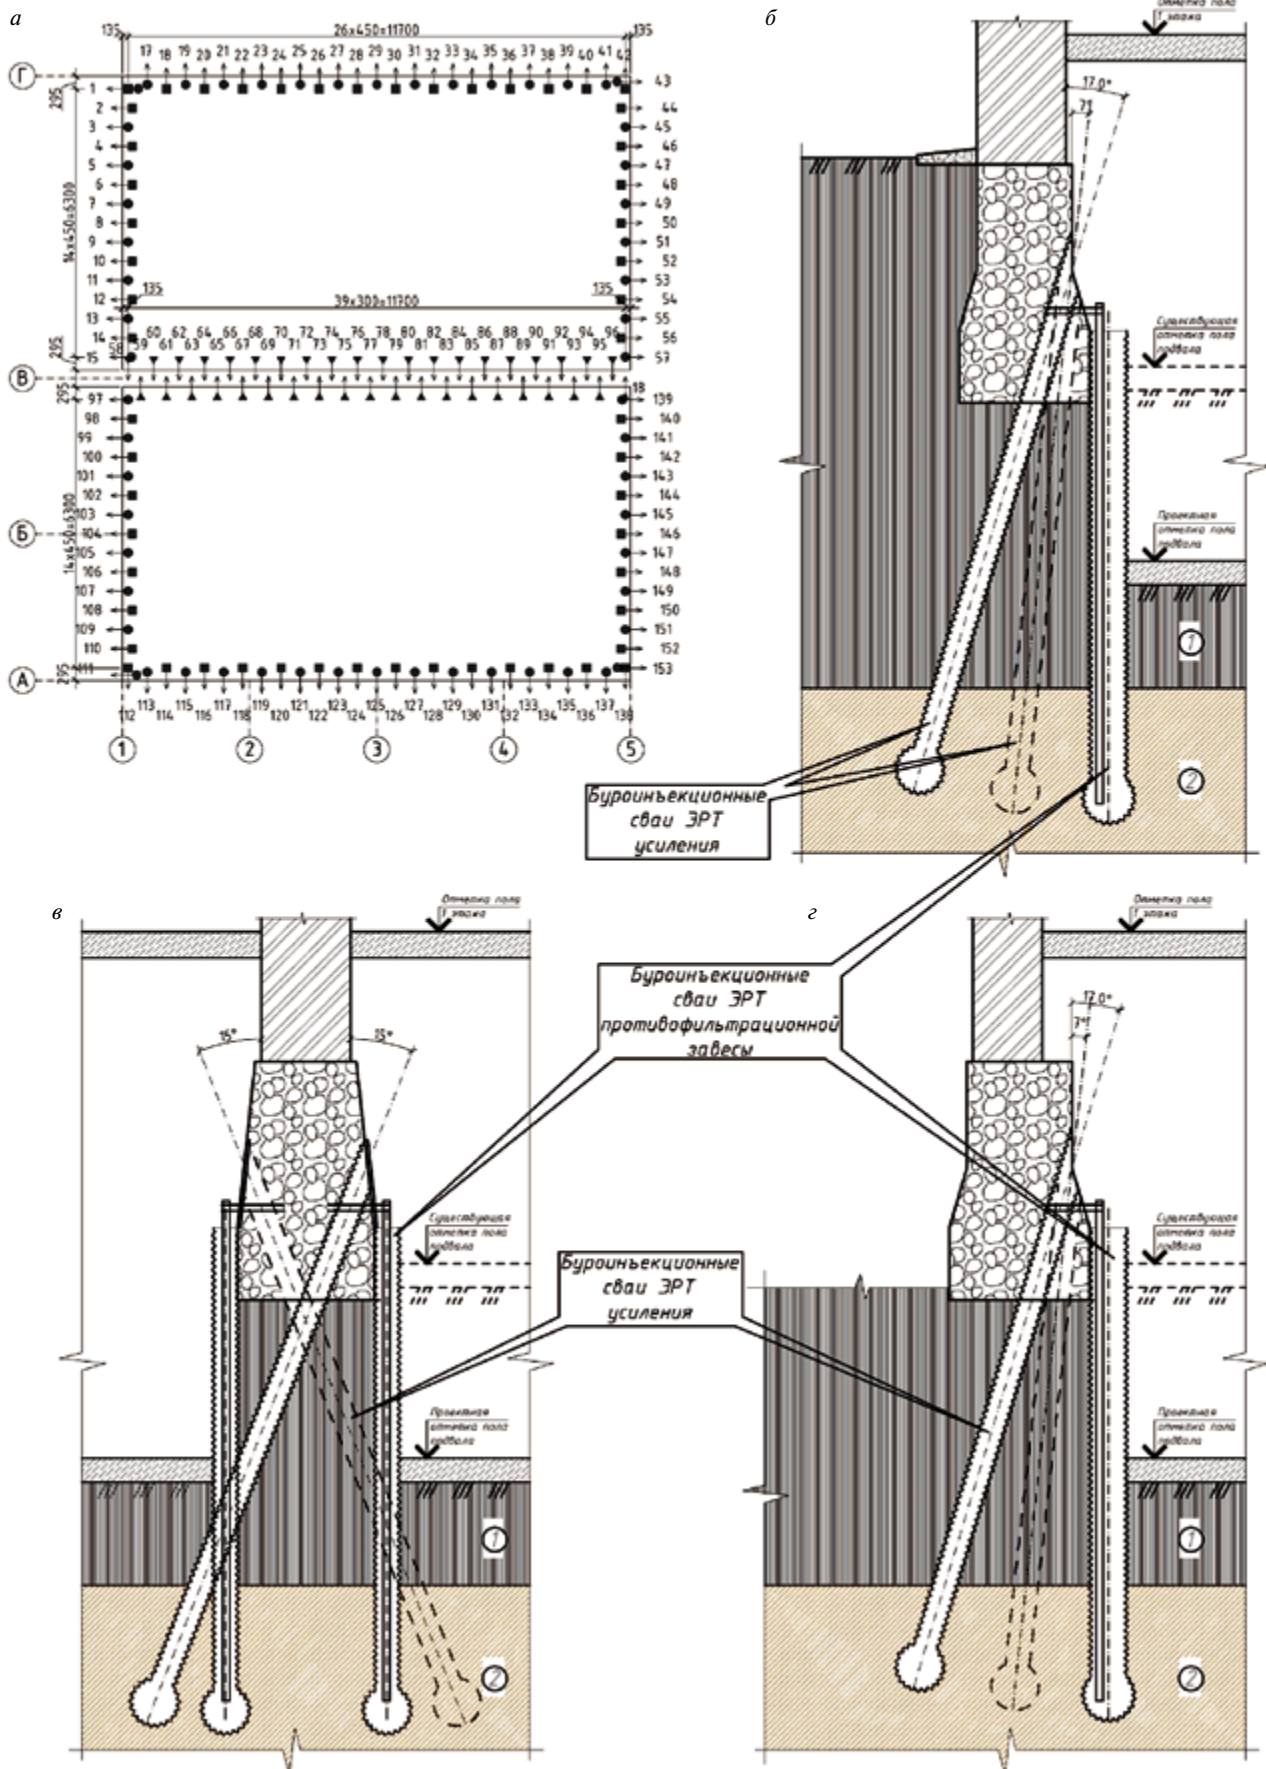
Схемы усиления основания фундаментов при понижении полов подвала: а – план буриinjекционных свай ЭРТ; б, в, г – сечения усиливаемых фундаментов
